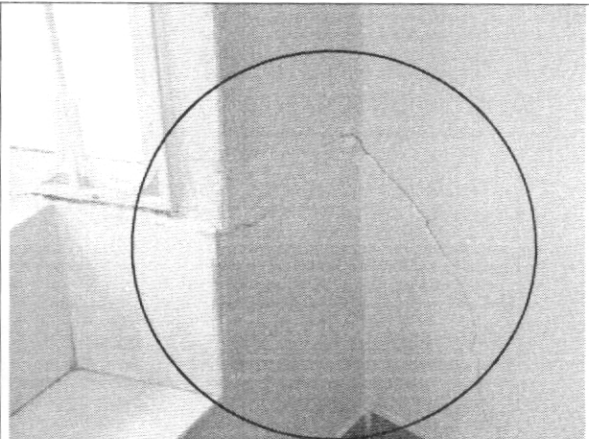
Grieta costado occidental, muros segundo piso
